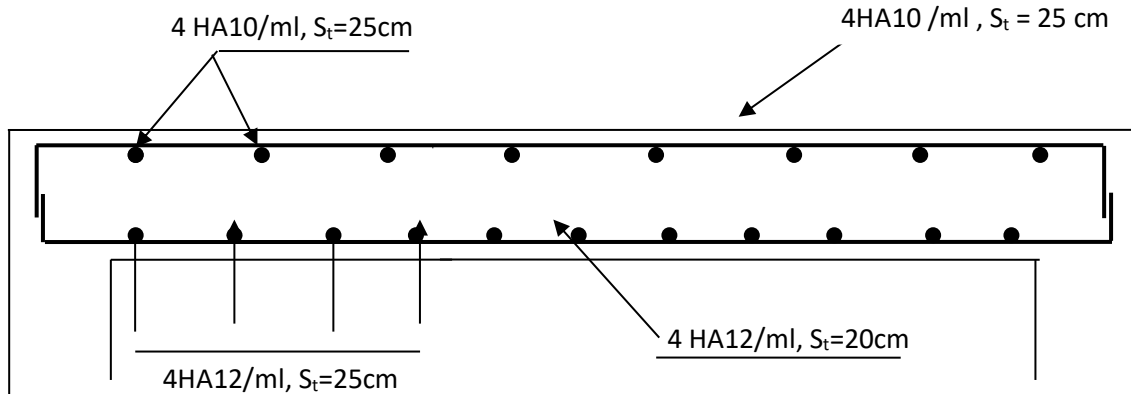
Plan de ferrailage de la salle machine suivant x-x.
